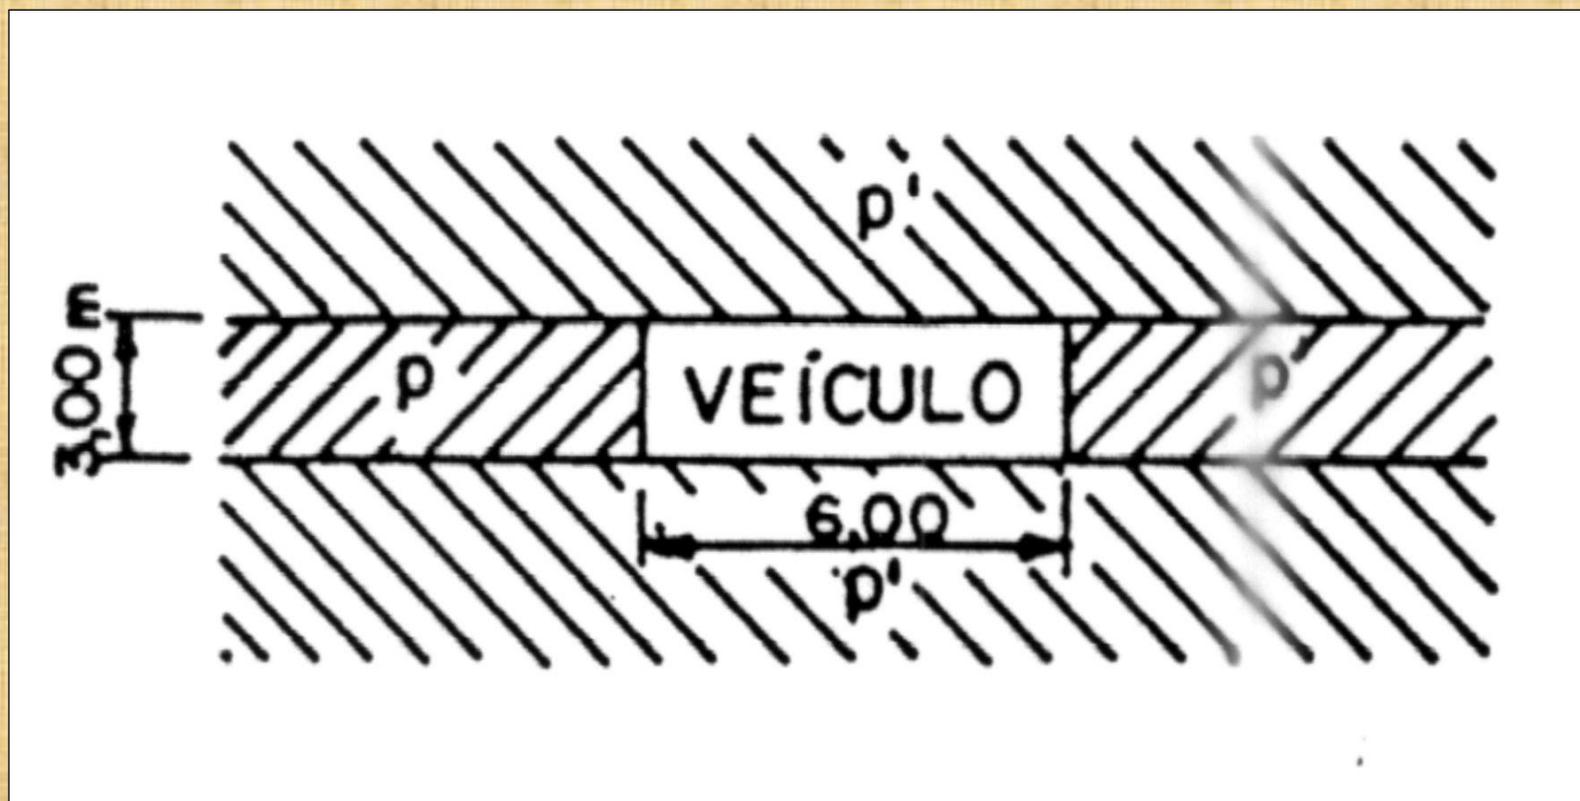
Disposição em planta segundo NB6/60 (ABNT, 1960)
